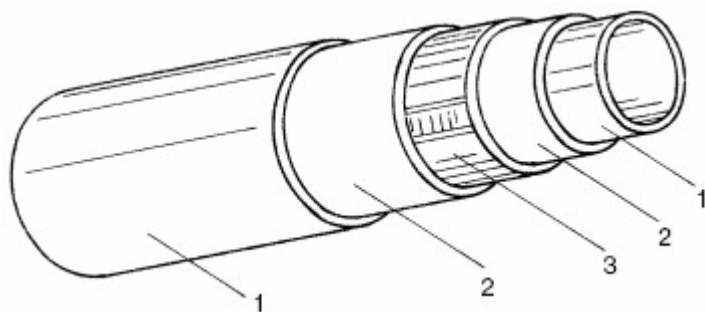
Металлополимерная труба: 1 – полиэтилен; 2 – клей для плотного соединения пластика и металла; 3 – алюминиевая фольга, сваренная внахлестку
